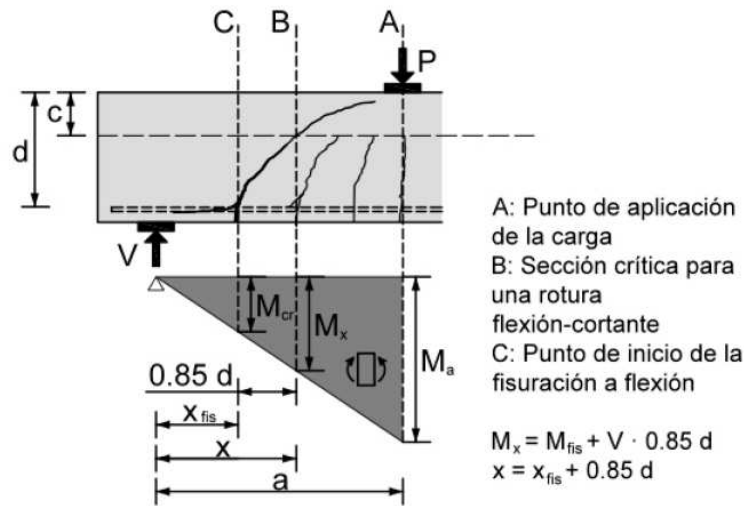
a. Situación de la fisura crítica (A. Marí)
